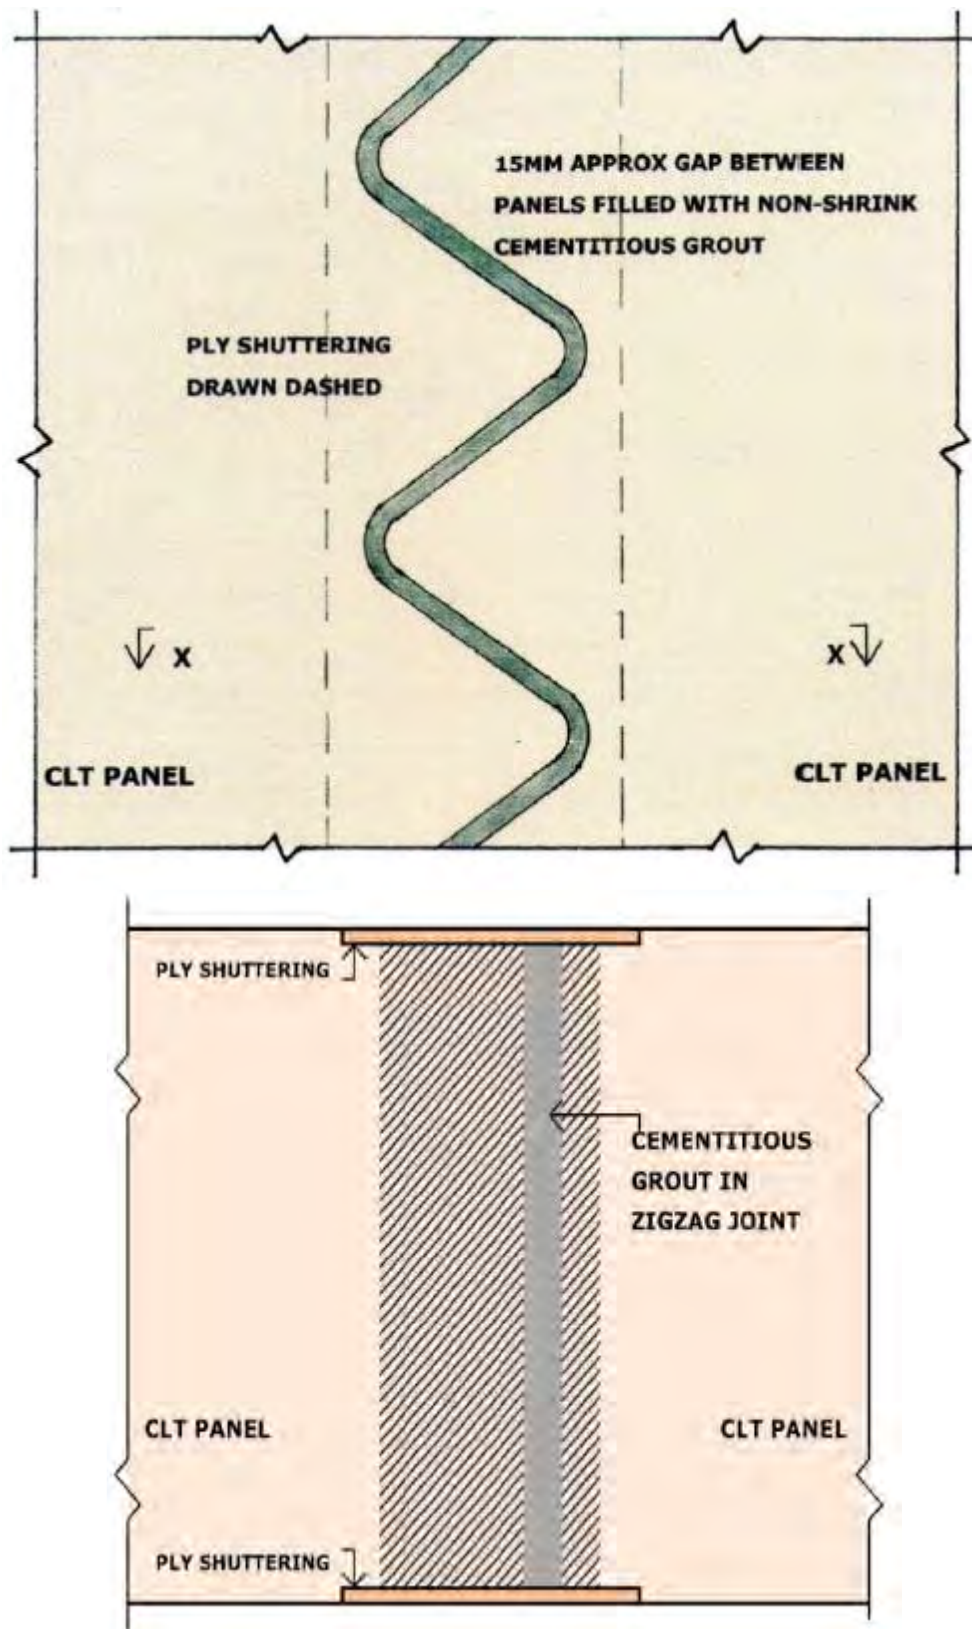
Particolari costruttivi del giunto di collegamento pannello-pannello. Immagine tratta da "Integrating cross-laminated timber panels to construct buildings to twenty levels" John Chapman.
